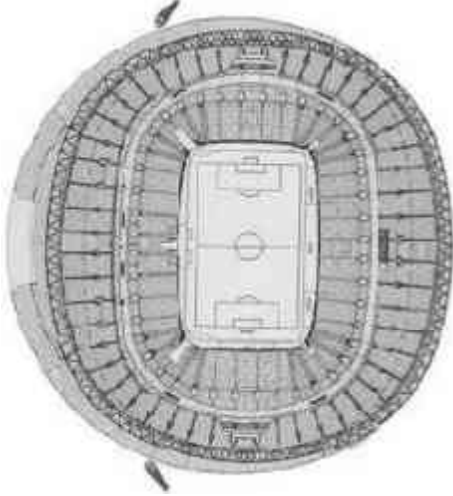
Planta arquitectónica del estadio Wembley.
